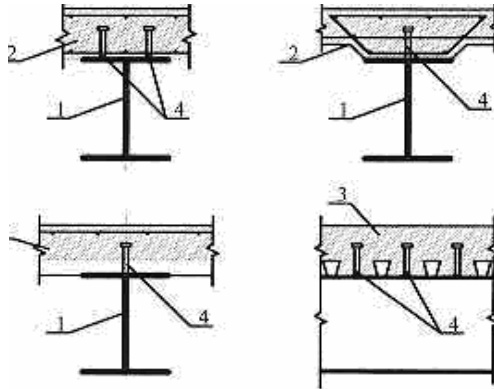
Поперечні перерізи типових сталезалізобетонних балок:
